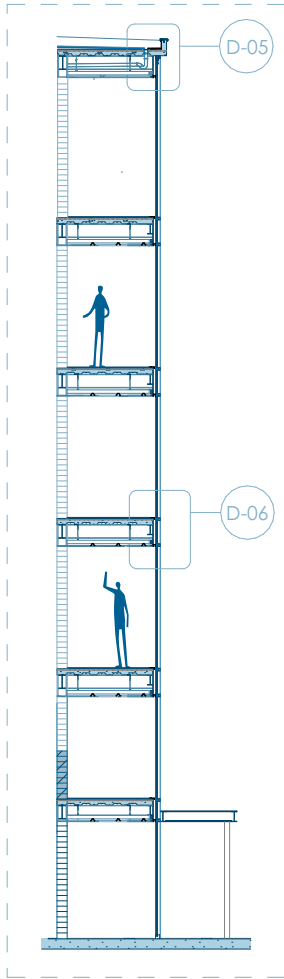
Sección constructiva C. Nota. Elaboración propia.
